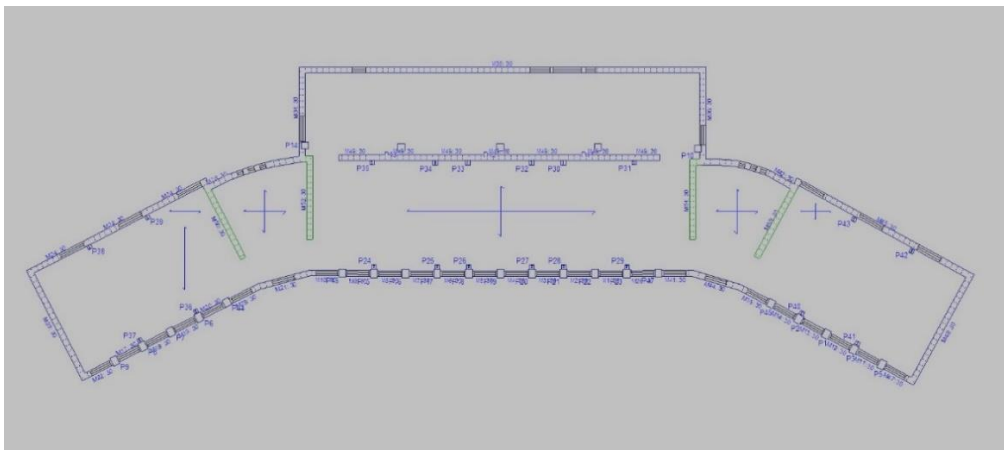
Planta 3 del modelo de 5 plantas simplificado
